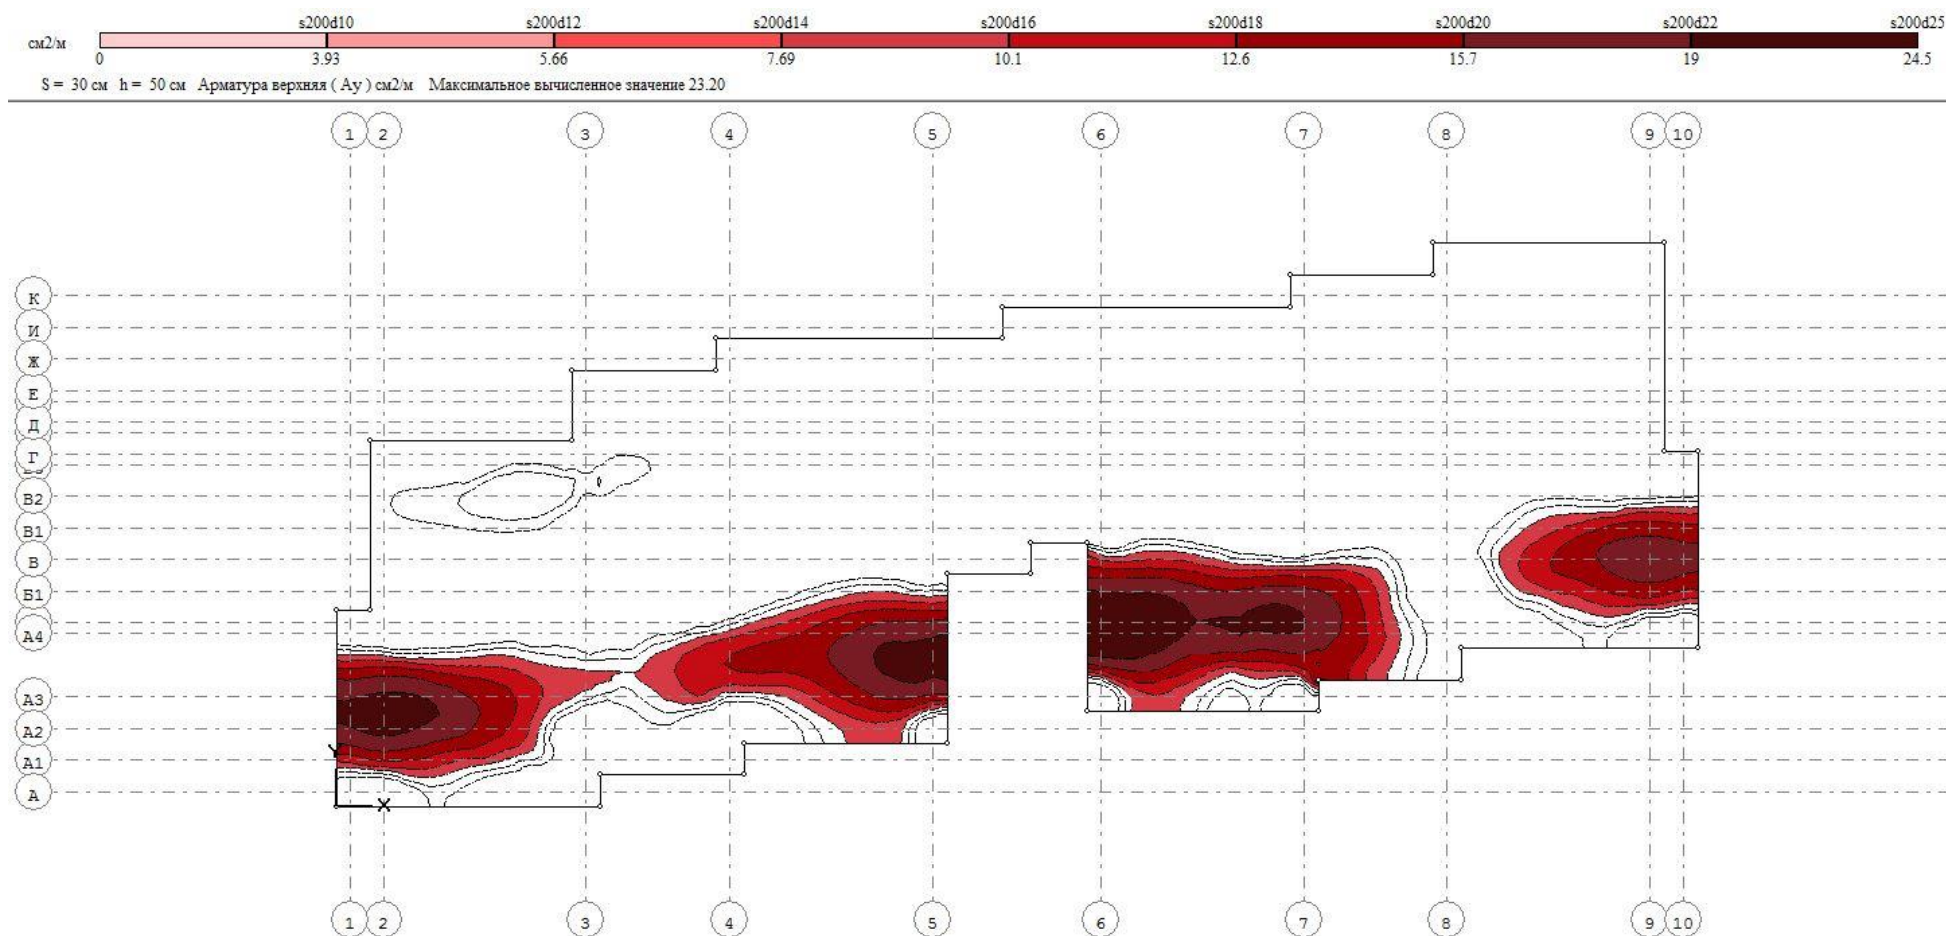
ділянки додаткового армування по напрямку осі Y у верхній грані фундаментної плити.
